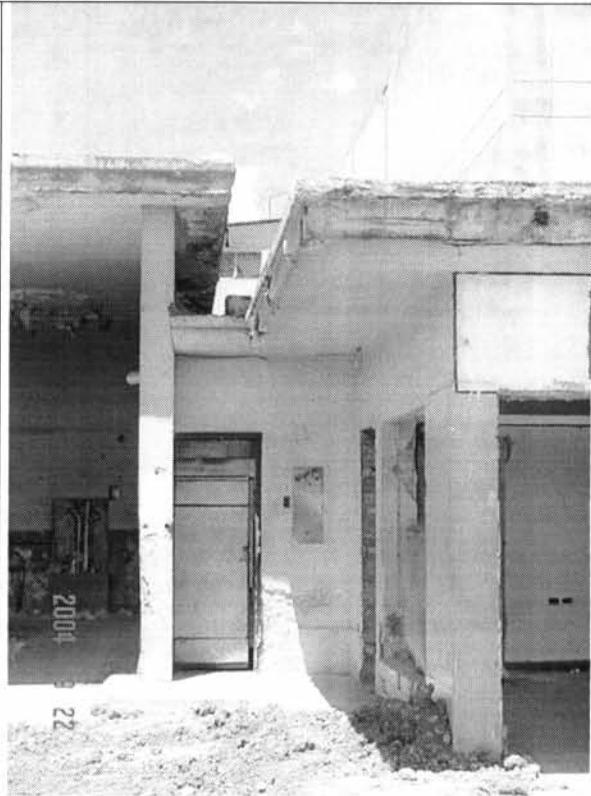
Zona de transición entre los dos sectores en que se dividió la estructura.
